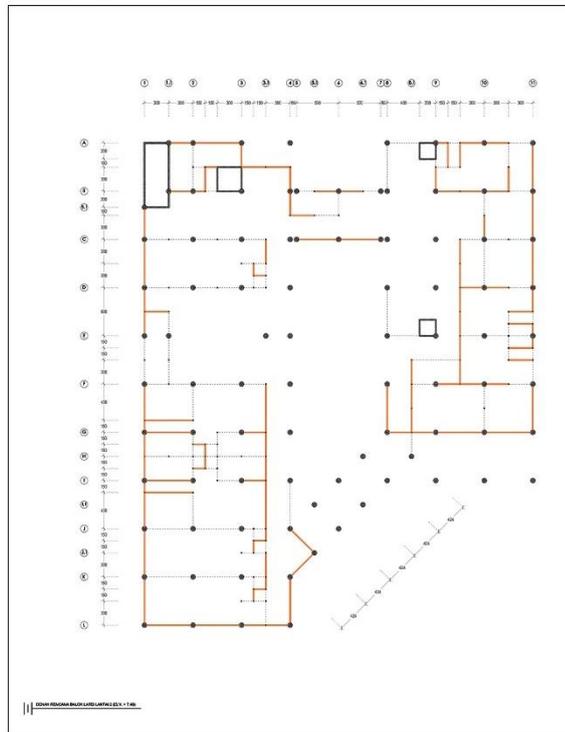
Denah Rencana Ring Balok Elv. + 13.50
